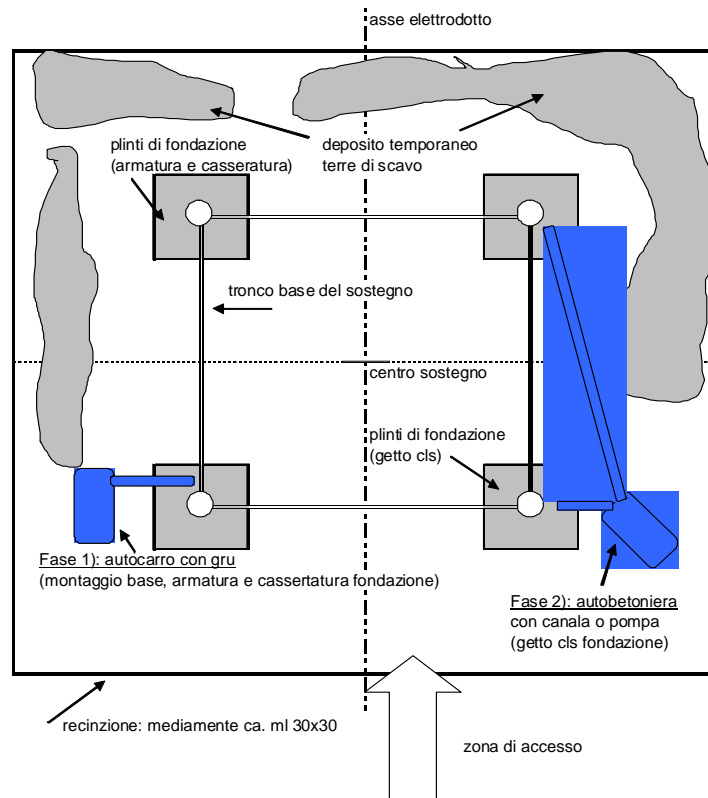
Planimetria dell'Area Sostegno (getto e basi)
